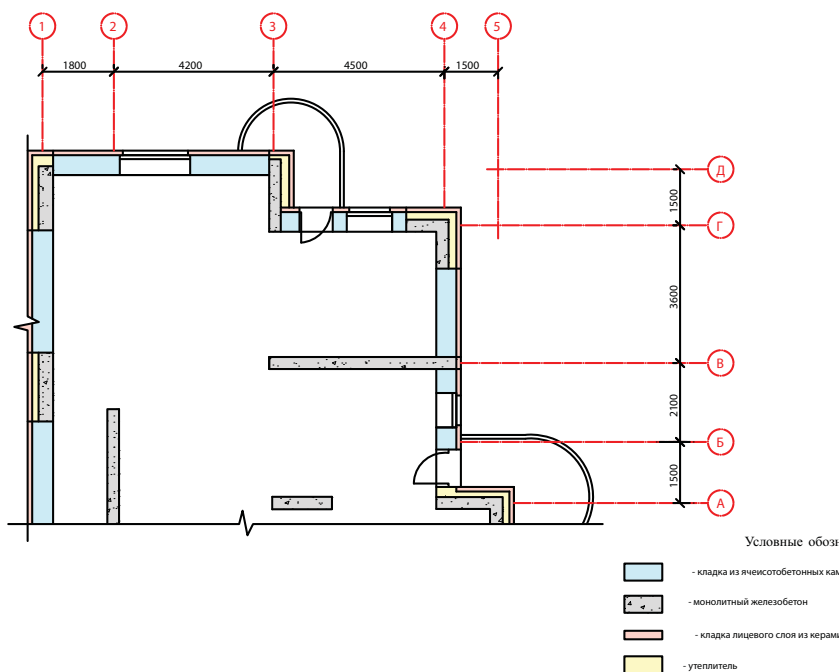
б Фрагмент плана типового этажа здания на ул. Магнитогорская в Москве
